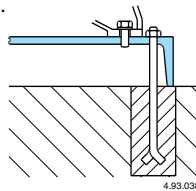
Fondazione per gruppo su piastra di base di profilato monolitico.
